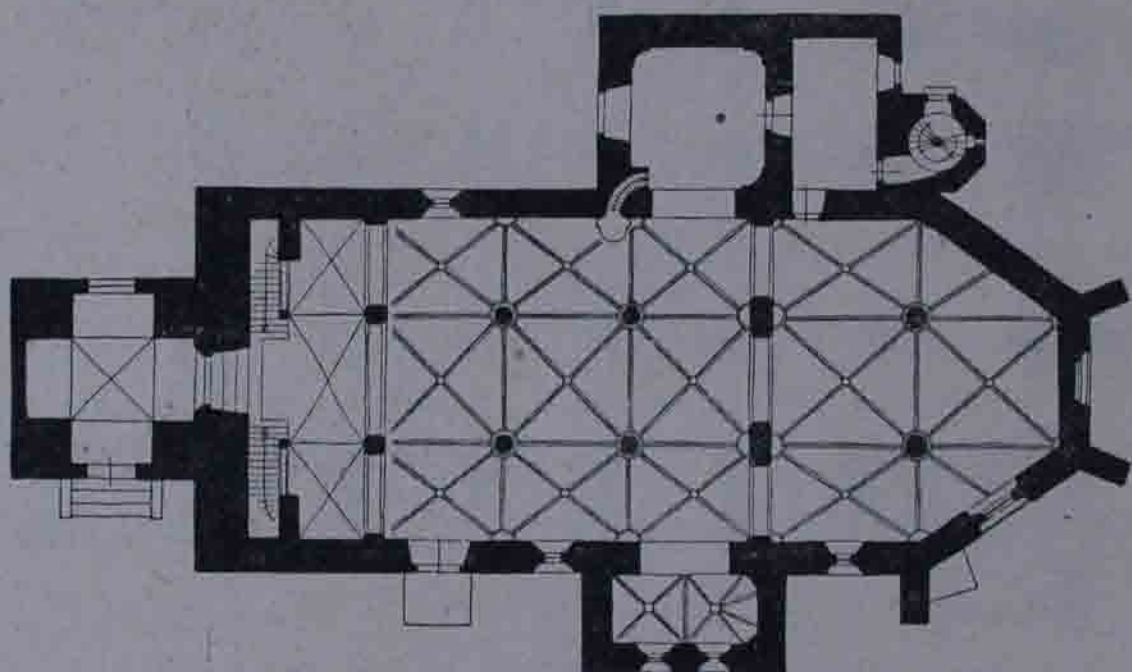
, Gumpoldskirchen, Pfarrkirche; Grundriß.
